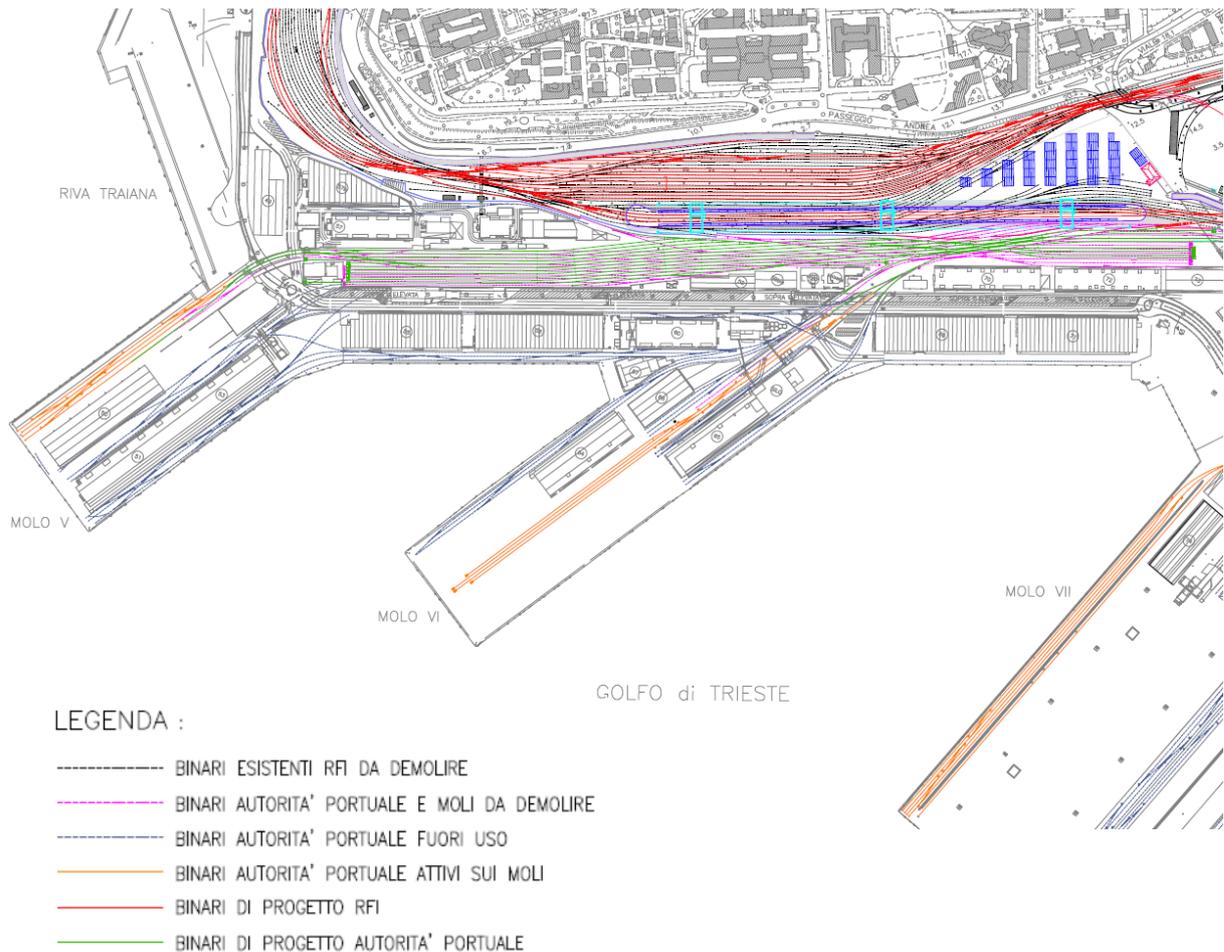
Planimetria Generale di Progetto sovrapposta allo stato di fatto
